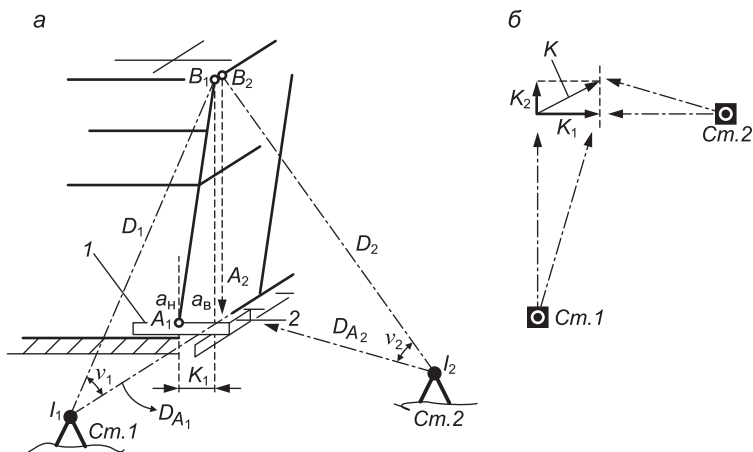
Определение крена стены здания способом вертикальной плоскости: а – схема проецирования; б – определение полной величины крена
